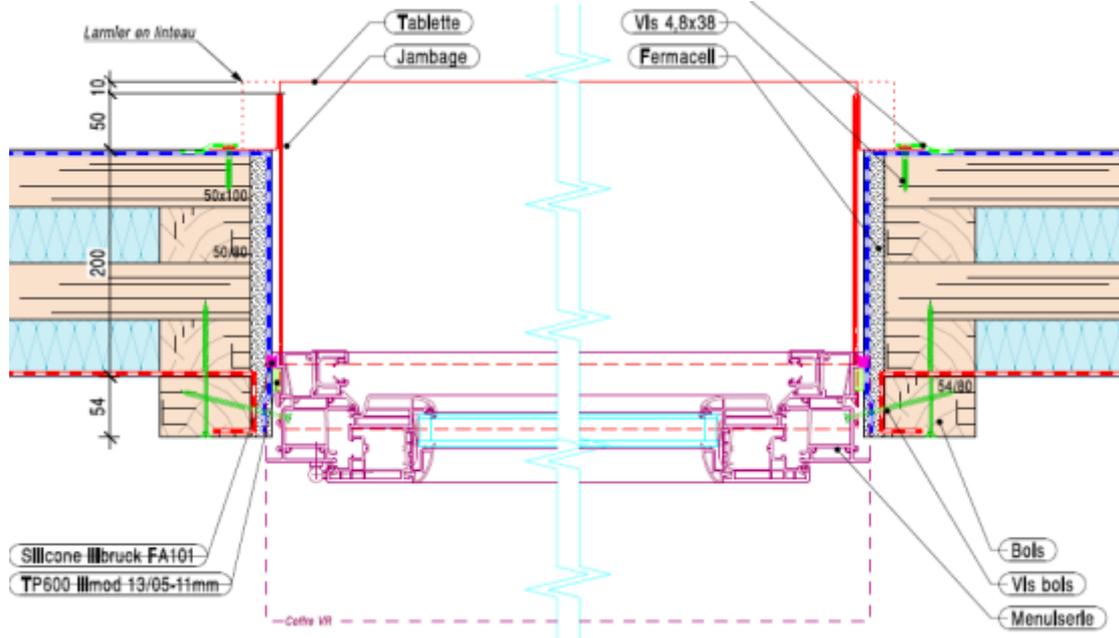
Essai AEV Menuiserie en tunnel / coupe horizontale
